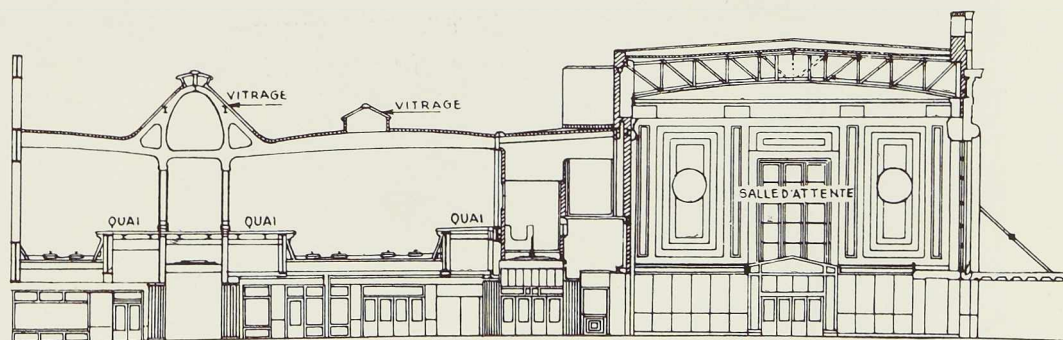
Coupe transversale à travers la nouvelle gare de Market Street. On notera la poutre en treillis qui porte la toiture et le faux plafond de la salle d'attente ; noter également les viaducs en acier des voies surélevées et la forme particulière de la charpente des toitures de ces voies.
